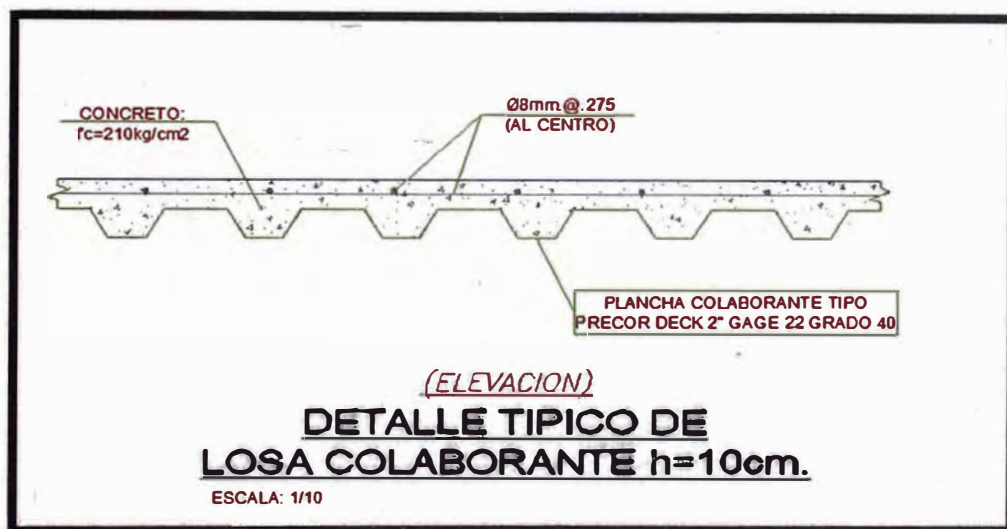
Detalle de losa colaborante de 0.10m de espesor.
